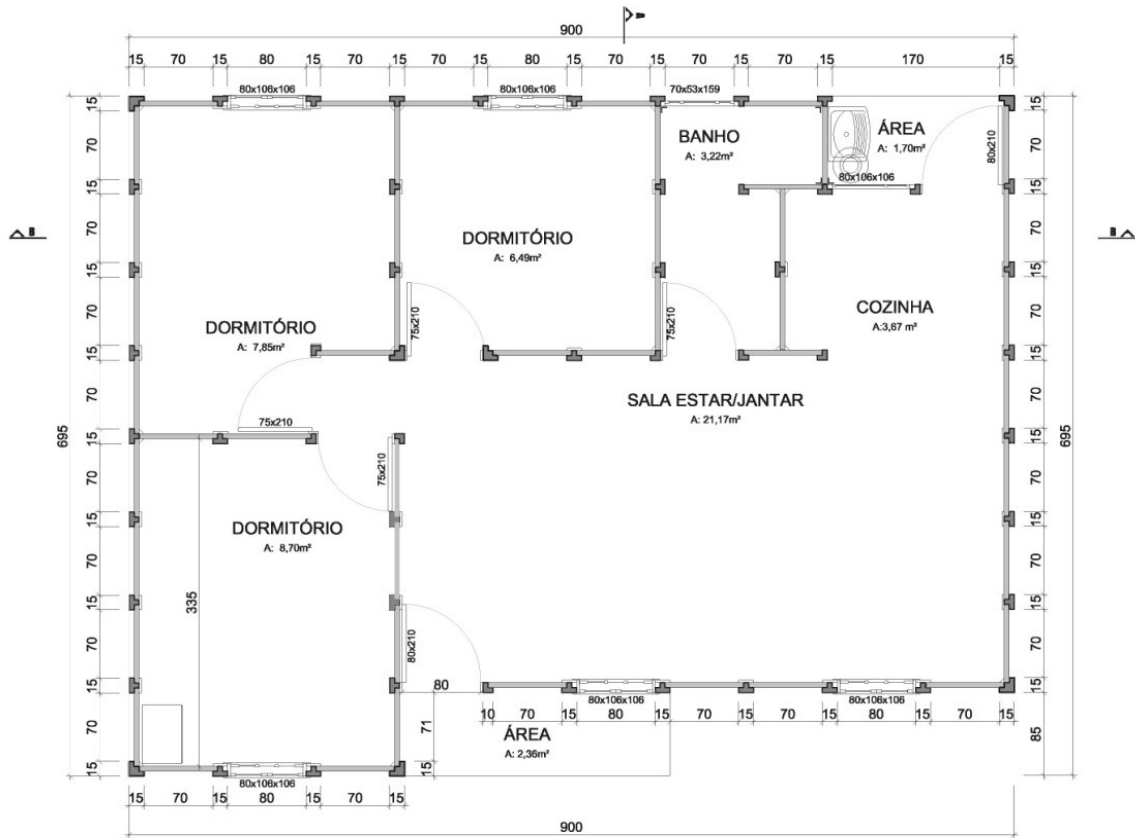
Planta baixa de locação dos pilares do projeto da residência de 59,60m².
